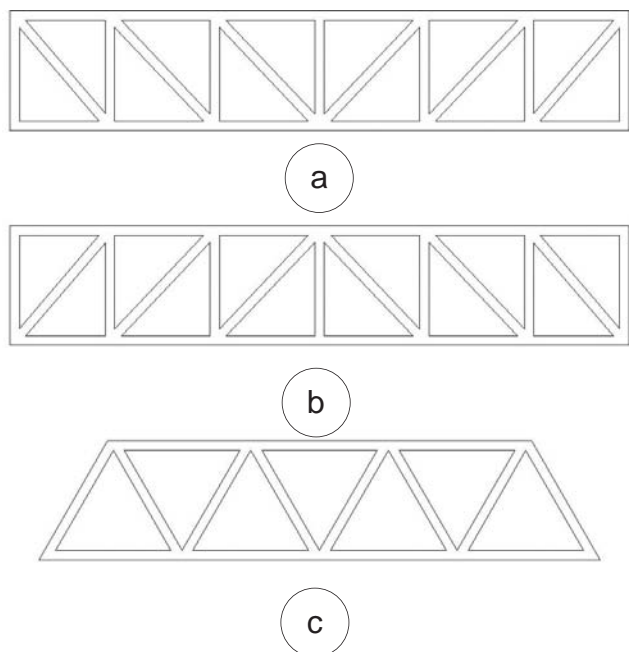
Algunos tipos de vigas de celosía planas para Steel Framing.
